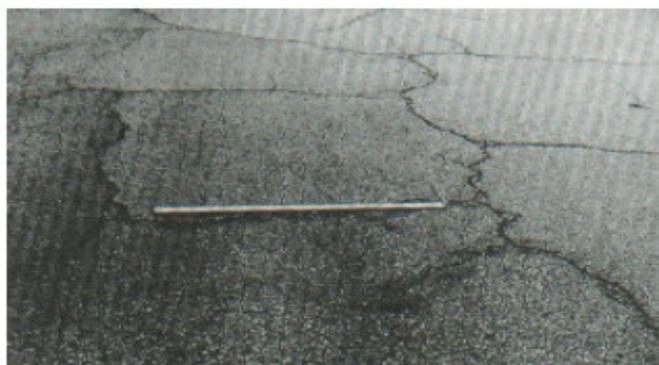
b : Grietas en bloque (Severidad media)
